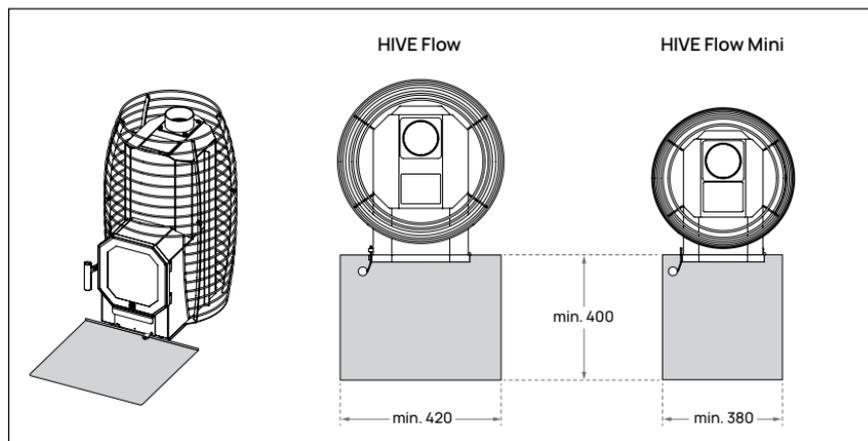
Piastra in lamiera HIVE Flow e Flow Mini per la protezione del pavimento (venduta separatamente).
